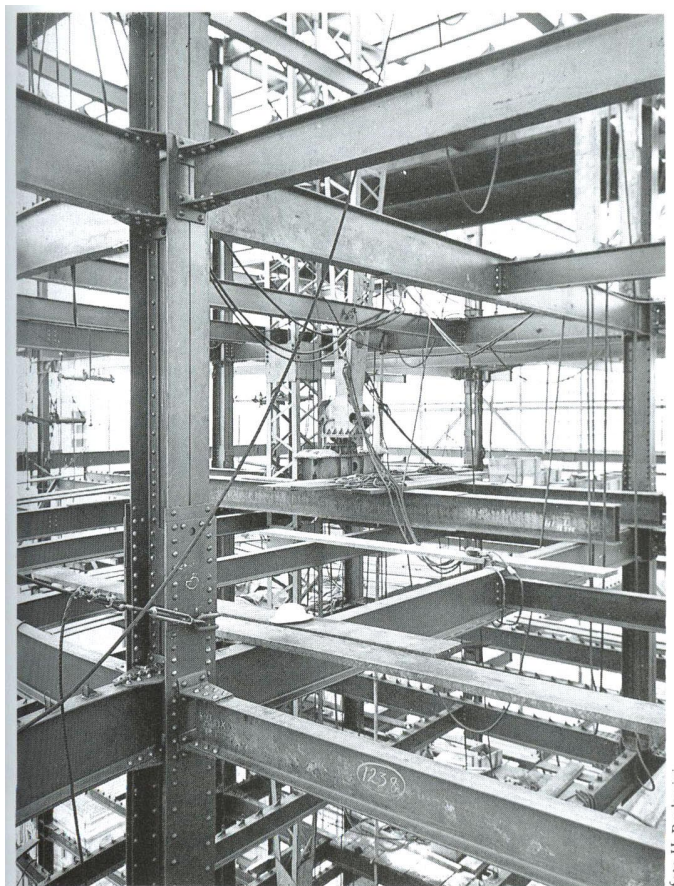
Interior do Edifício Palácio do Comércio: montagem da estrutura metálica com o “guy derrick” no sétimo pavimento
